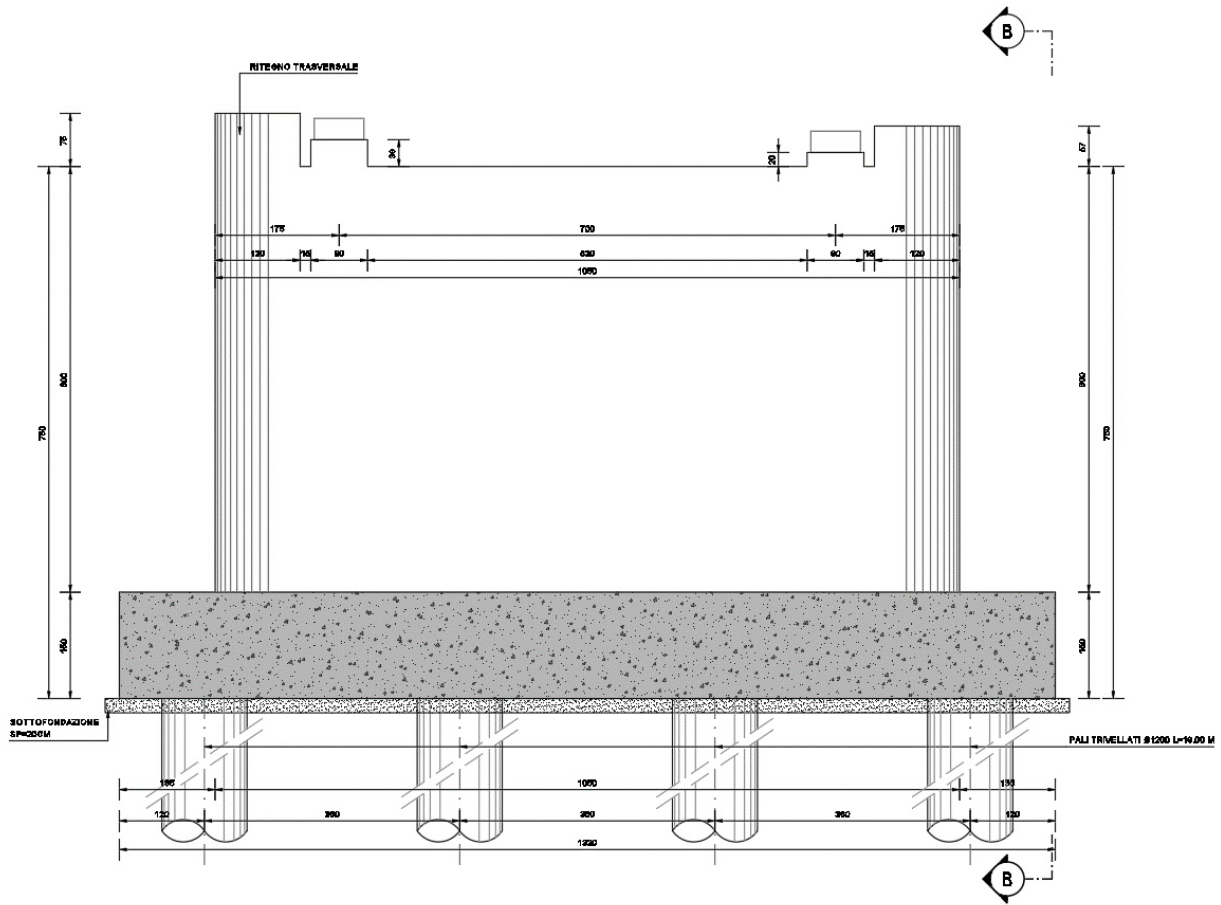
SEZIONE LONGITUDINALE PILA
